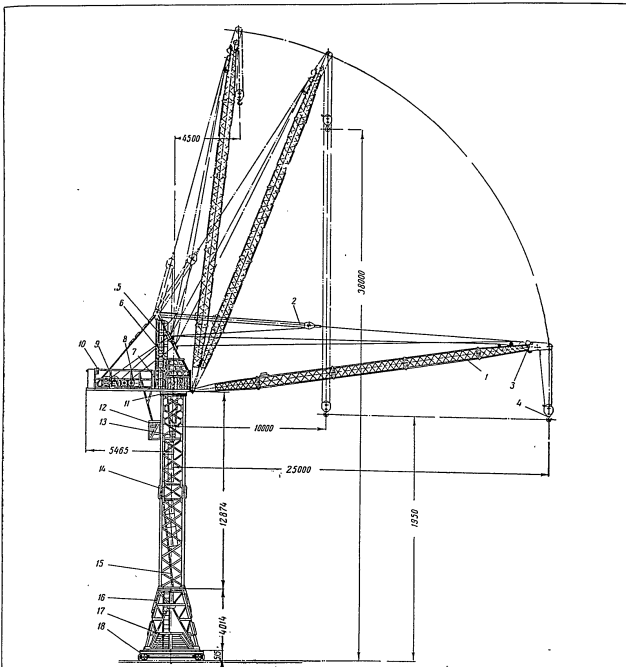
Самоходный полноповоротный башенный кран Т-178: 1 — стрела; 2 — полиспаст подъема стрелы; 3 — ограничитель подъема; 4 — крюк с обоймой; 5 — стойка с блоками; 6 — кабина; 7 — поворотный механизм; 8 — лебедка подъема груза; 9 — стрелоподъемная лебедка; 10 — противовесная консоль с механизмами; 11 — верхние опорные катки; 12 — переходный мостик; 13 — нижняя опора хвостовика; 14 — башня; 15 — лестница; 16 — нижняя пирамидальная опора; 17 — балласт; 18 — ходовая часть.
